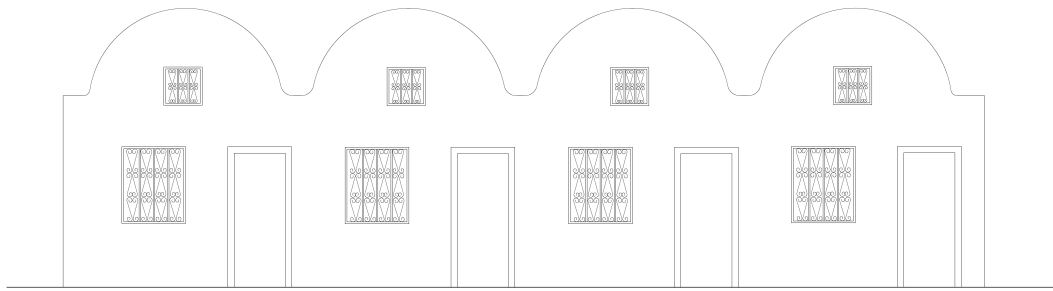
Schéma d'une façade de type vernaculaire à un étage avec porte en bois et fenêtres à grilles en fer forgé
